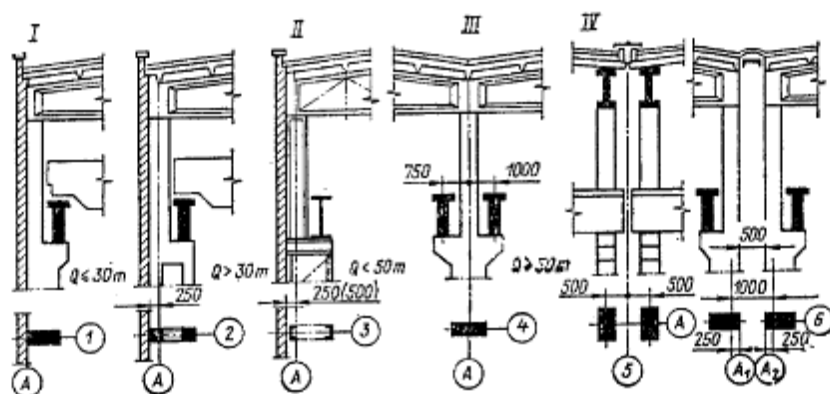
Привязка элементов зданий к разбивочным осям зданий, оборудованных кранами: I – железобетонные колонны с шагом 6 и 12 м; II – стальные колонны; III – средние ряды колонн; IV – температурные швы; продольные оси обозначены буквами, поперечные оси (ряды) – цифрами.
